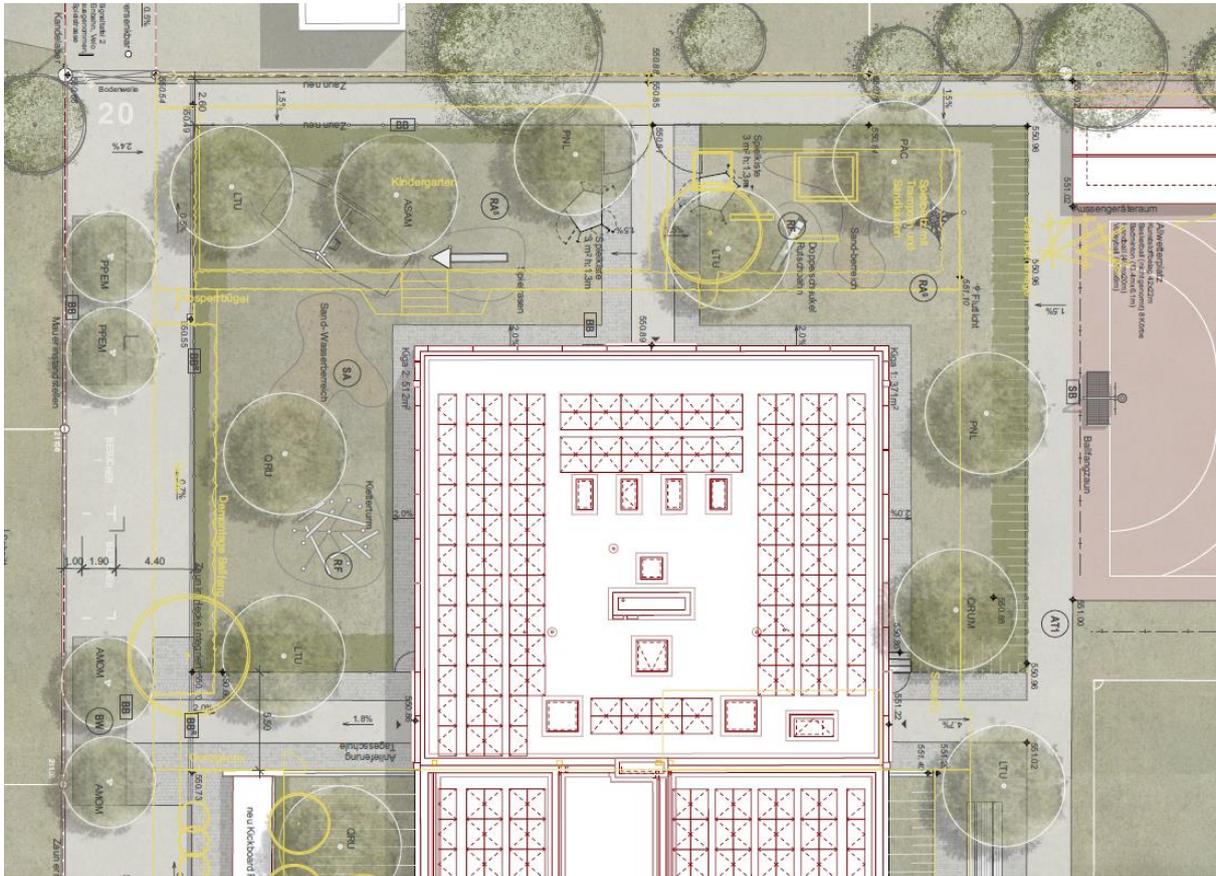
Dachaufsicht und Umgebung Erweiterungsbau
